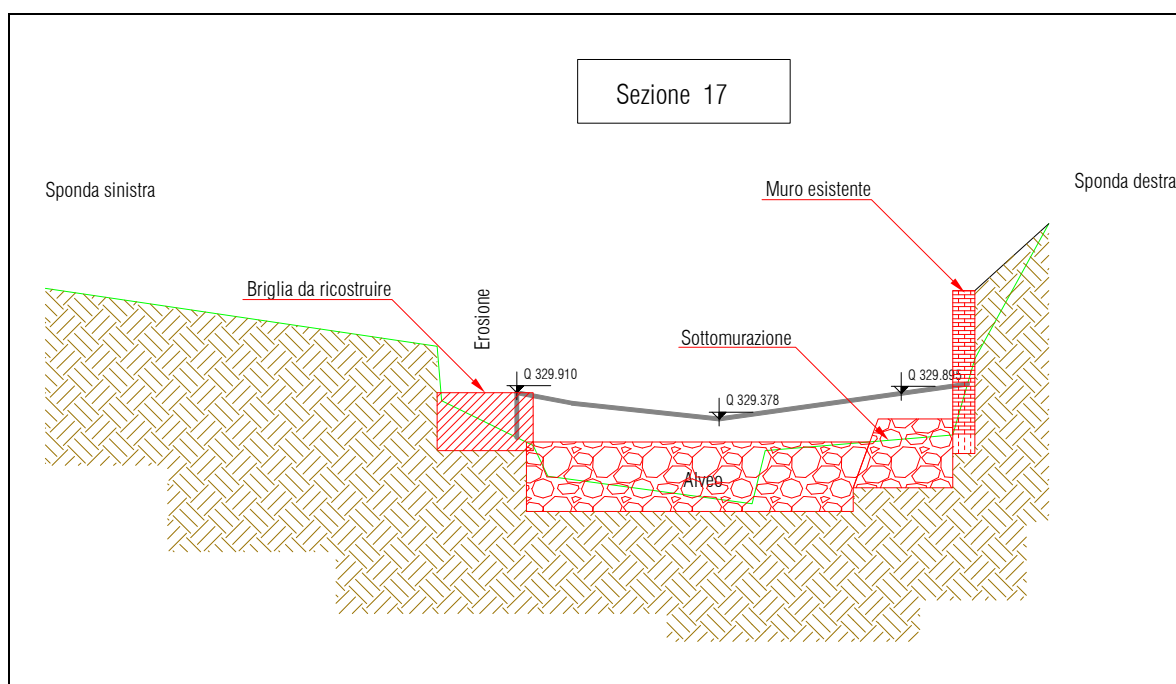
Sezione della briglia e muro gravemente eroso al piede
